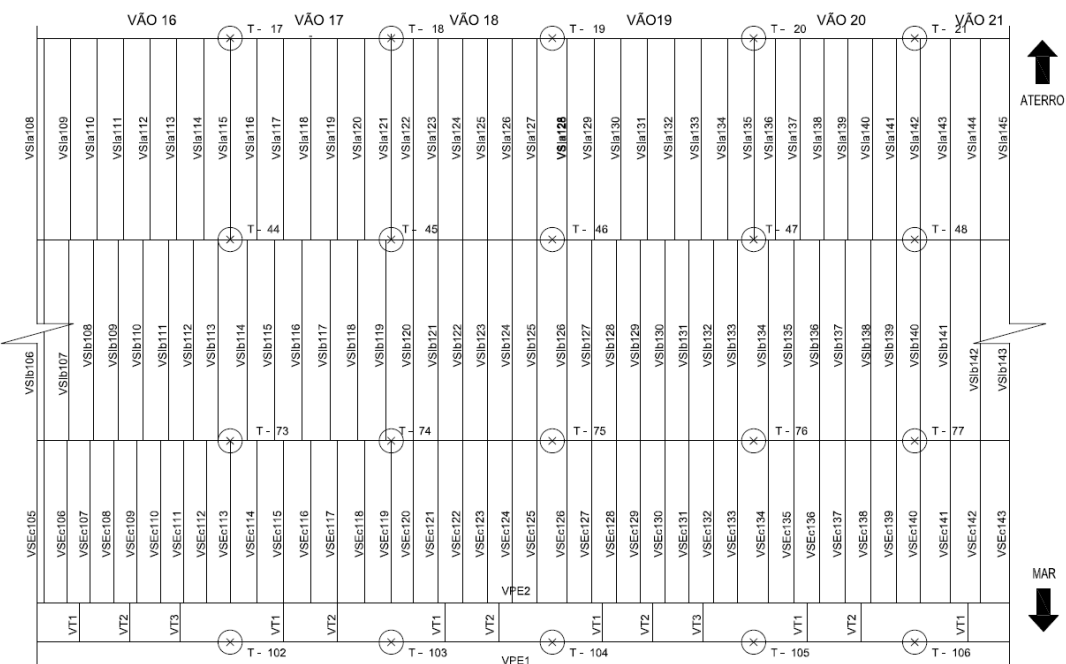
Planta do Berço 103 entre Vãos 16 e 21
